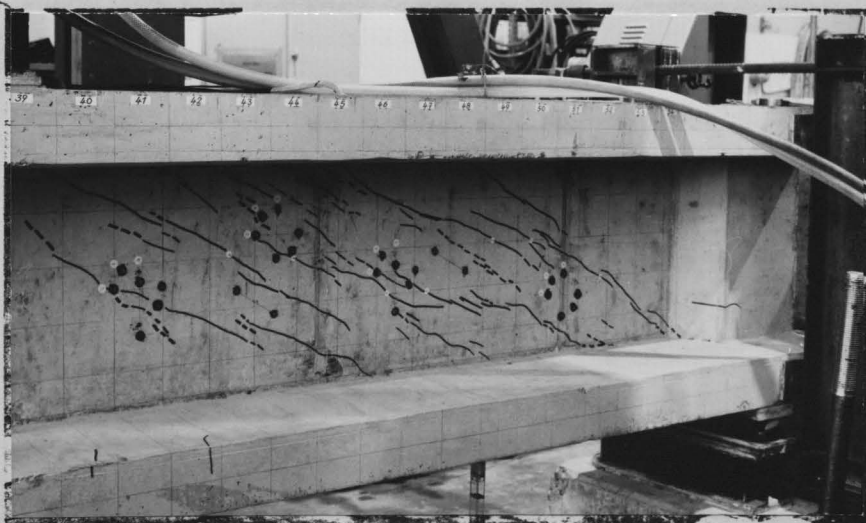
Rißbild Balken B4, 2. Laststellung
